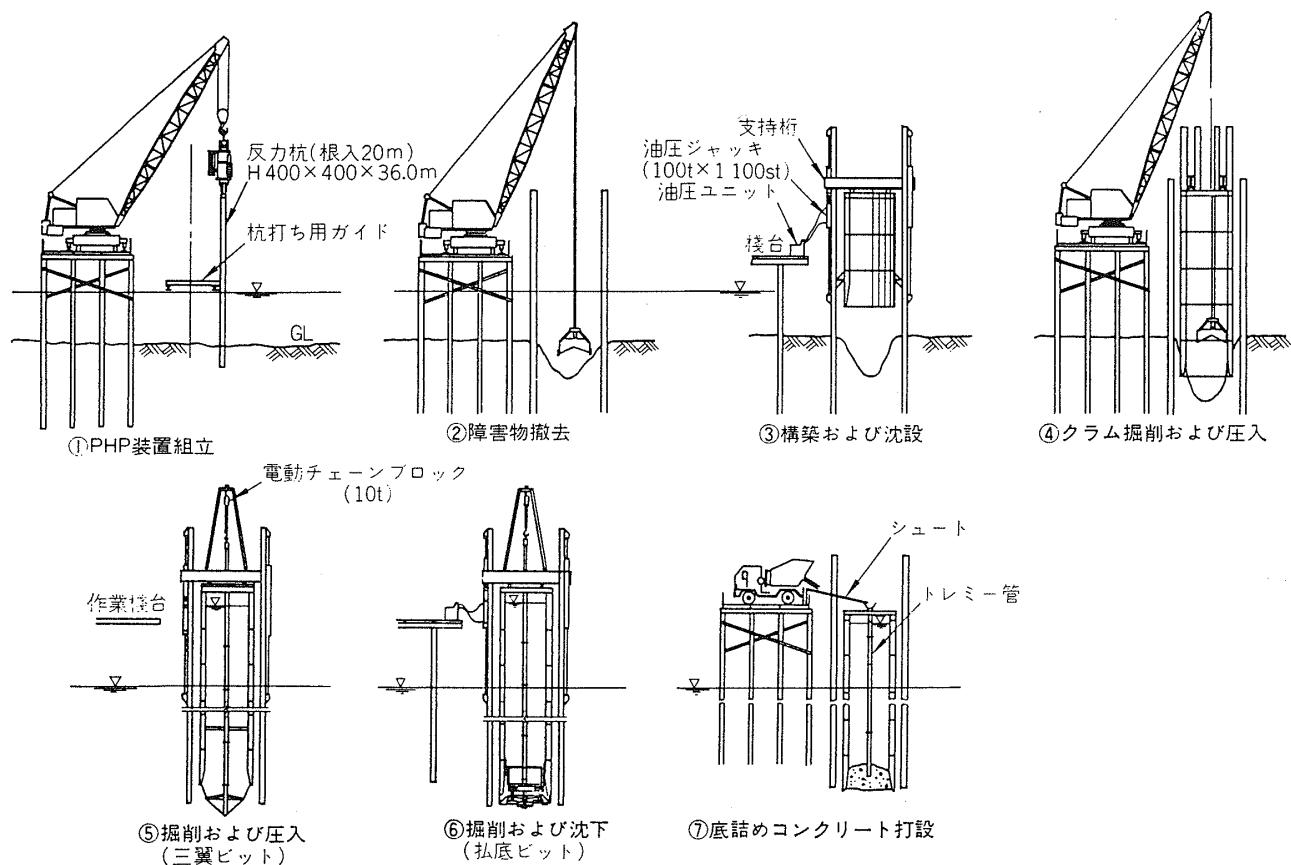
リバース工法によるPCウェルの施工例¹⁸⁹⁾
